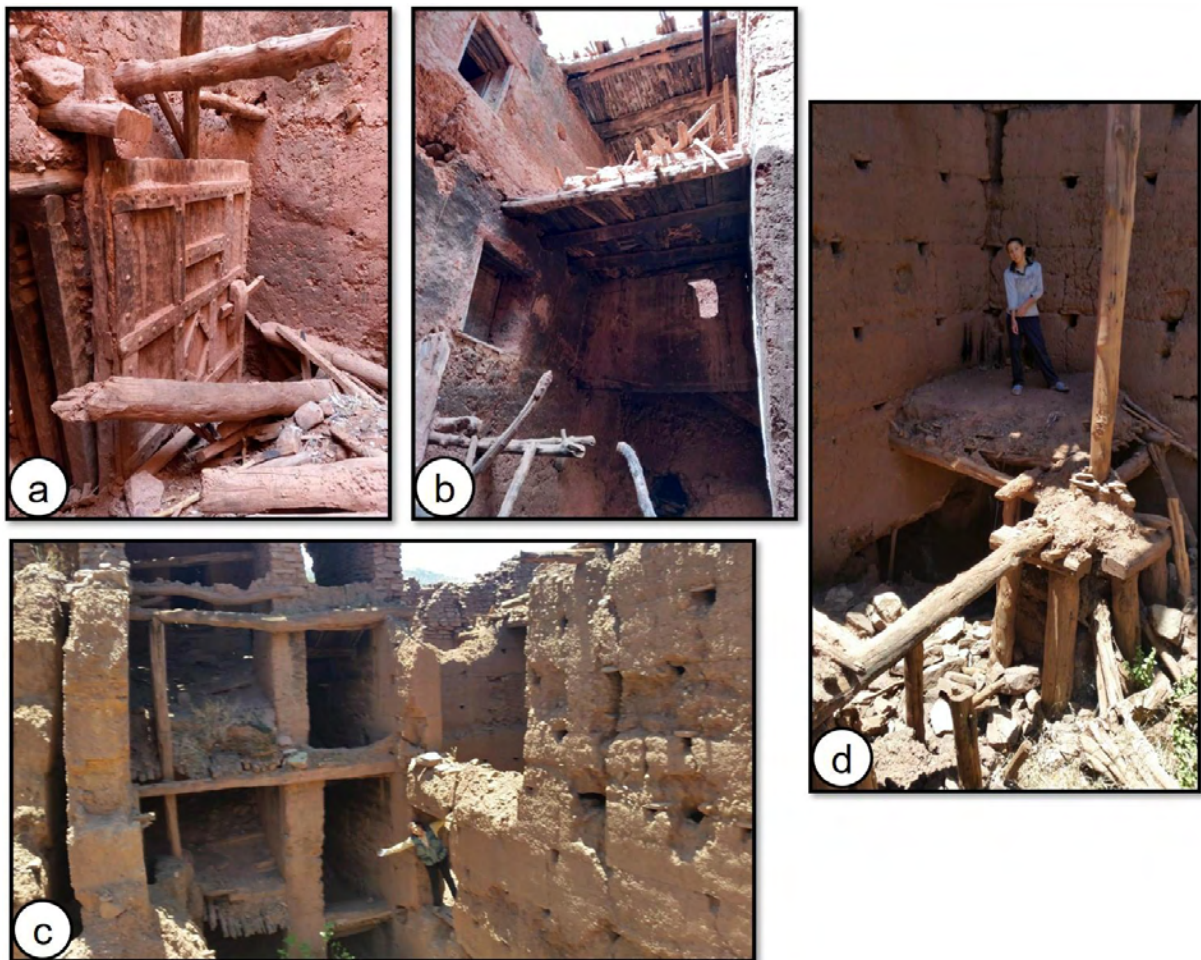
Les photos montrent l'utilisation du bois au niveau du grenier : a) Porte en bois massif ; b, c, d) Charpentes et poutres
